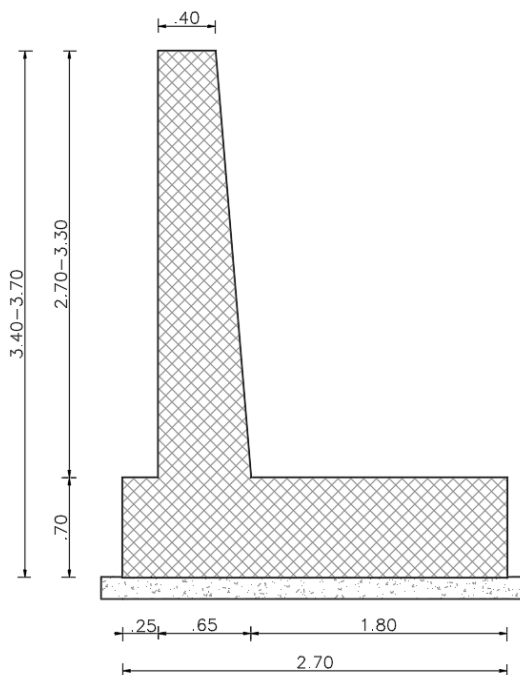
Sezione trasversale Muro Tipo 5 – Viabilità NV02B
